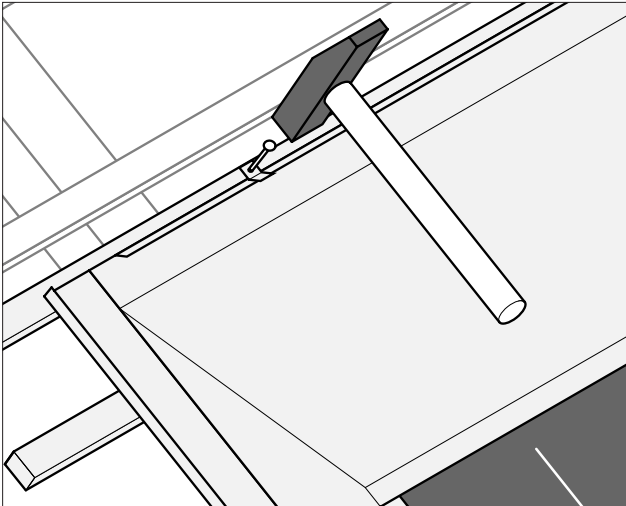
Obere Abdeckbleche mit je 2 Blechhaften auf der Dachlatte befestigen.
